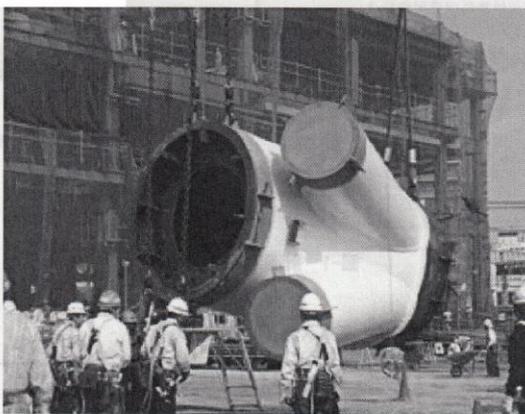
塔体を使用される鉄骨の据付状況(直径2300 mm)
